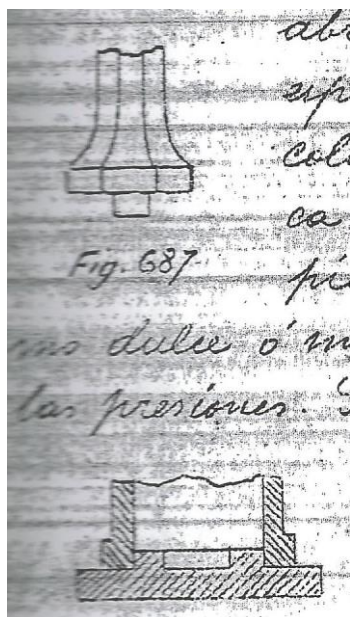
Detalle de implantación de columnas de fundición en el cemento. Fuente: (Anónimo, 1909).
